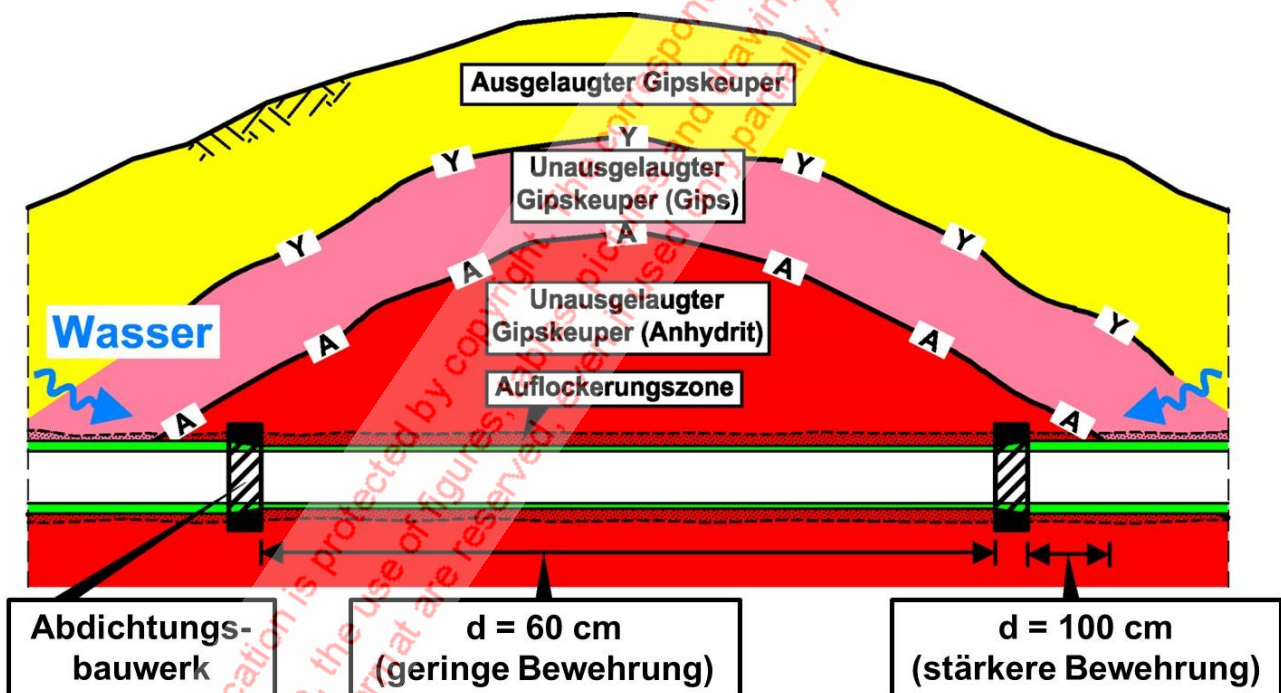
Fildertunnel und Tunnel nach Ober-/Untertürkheim
